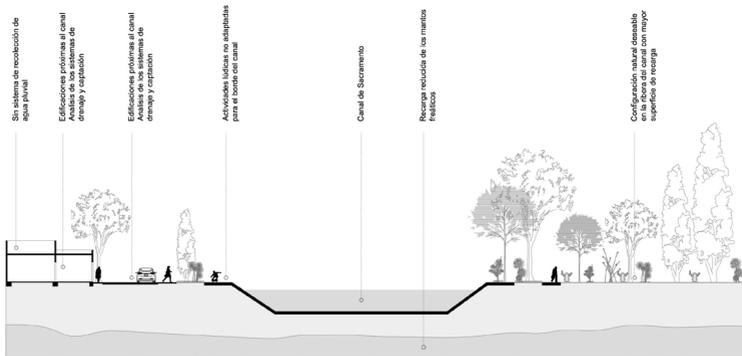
Corte esquemático estado actual canal de Sacramento.
